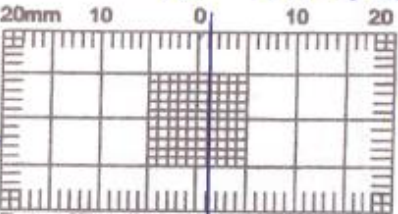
Medición de fisuras en concreto con adición 0.60 PEAD
